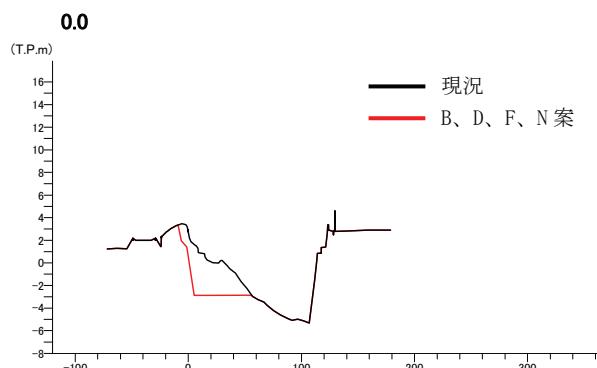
(1)　揖保川河口域の掘削位置及び河道断面図
